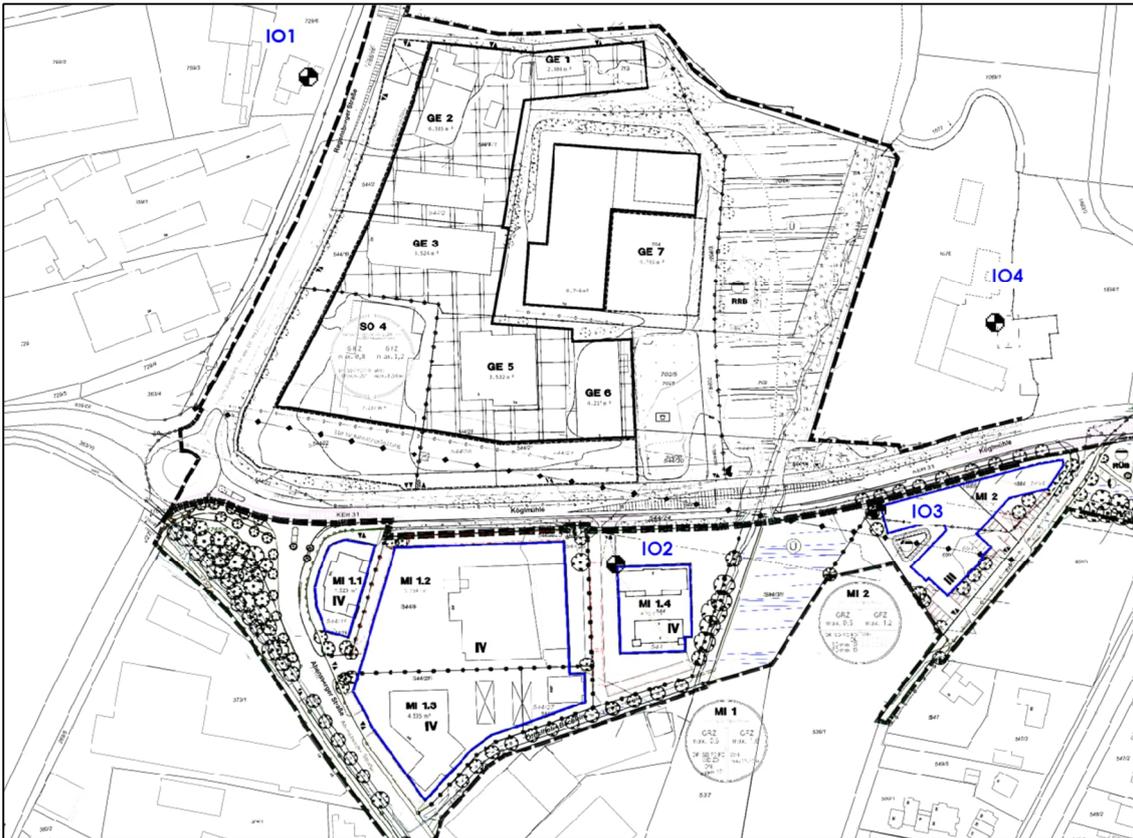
Lageplan mit Eintragung der maßgeblichen Immissionsorte (IO)
